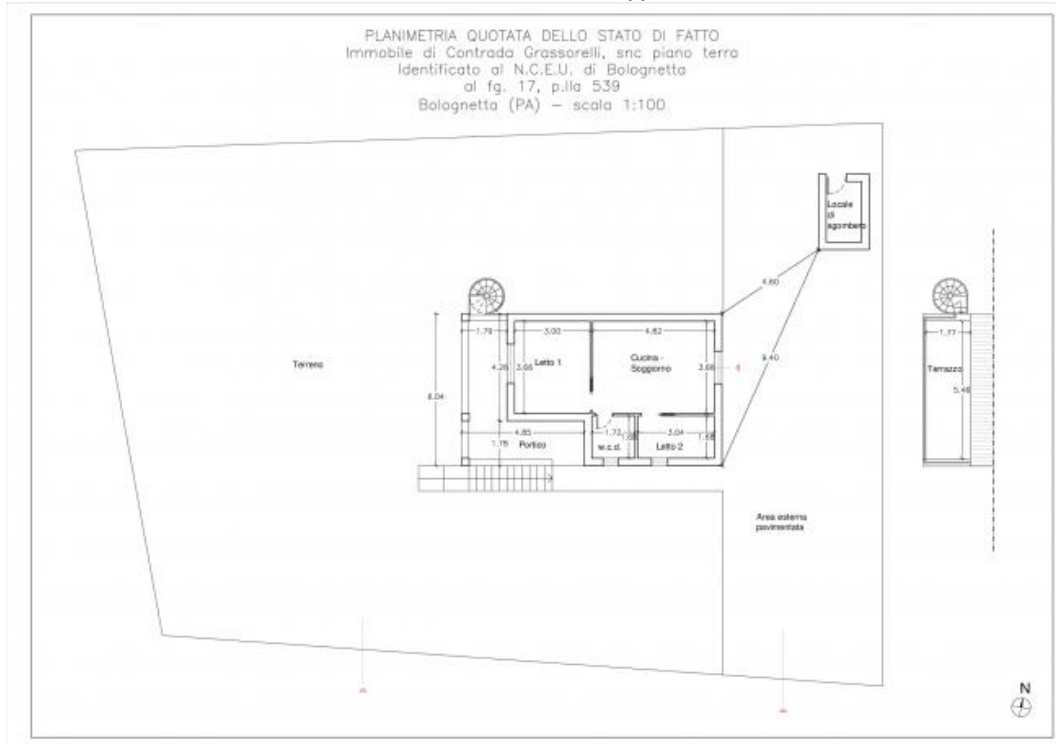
p.lla 539 - Planimetria quotata dello stato di fatto
